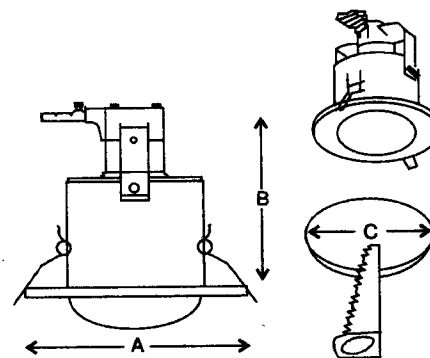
Типовая конструкция точечного неповоротного светильника под лампу накаливания с защитным кожухом: А — внешний диаметр светильника; В — глубина всей его установки; С — диаметр посадочного отверстия
